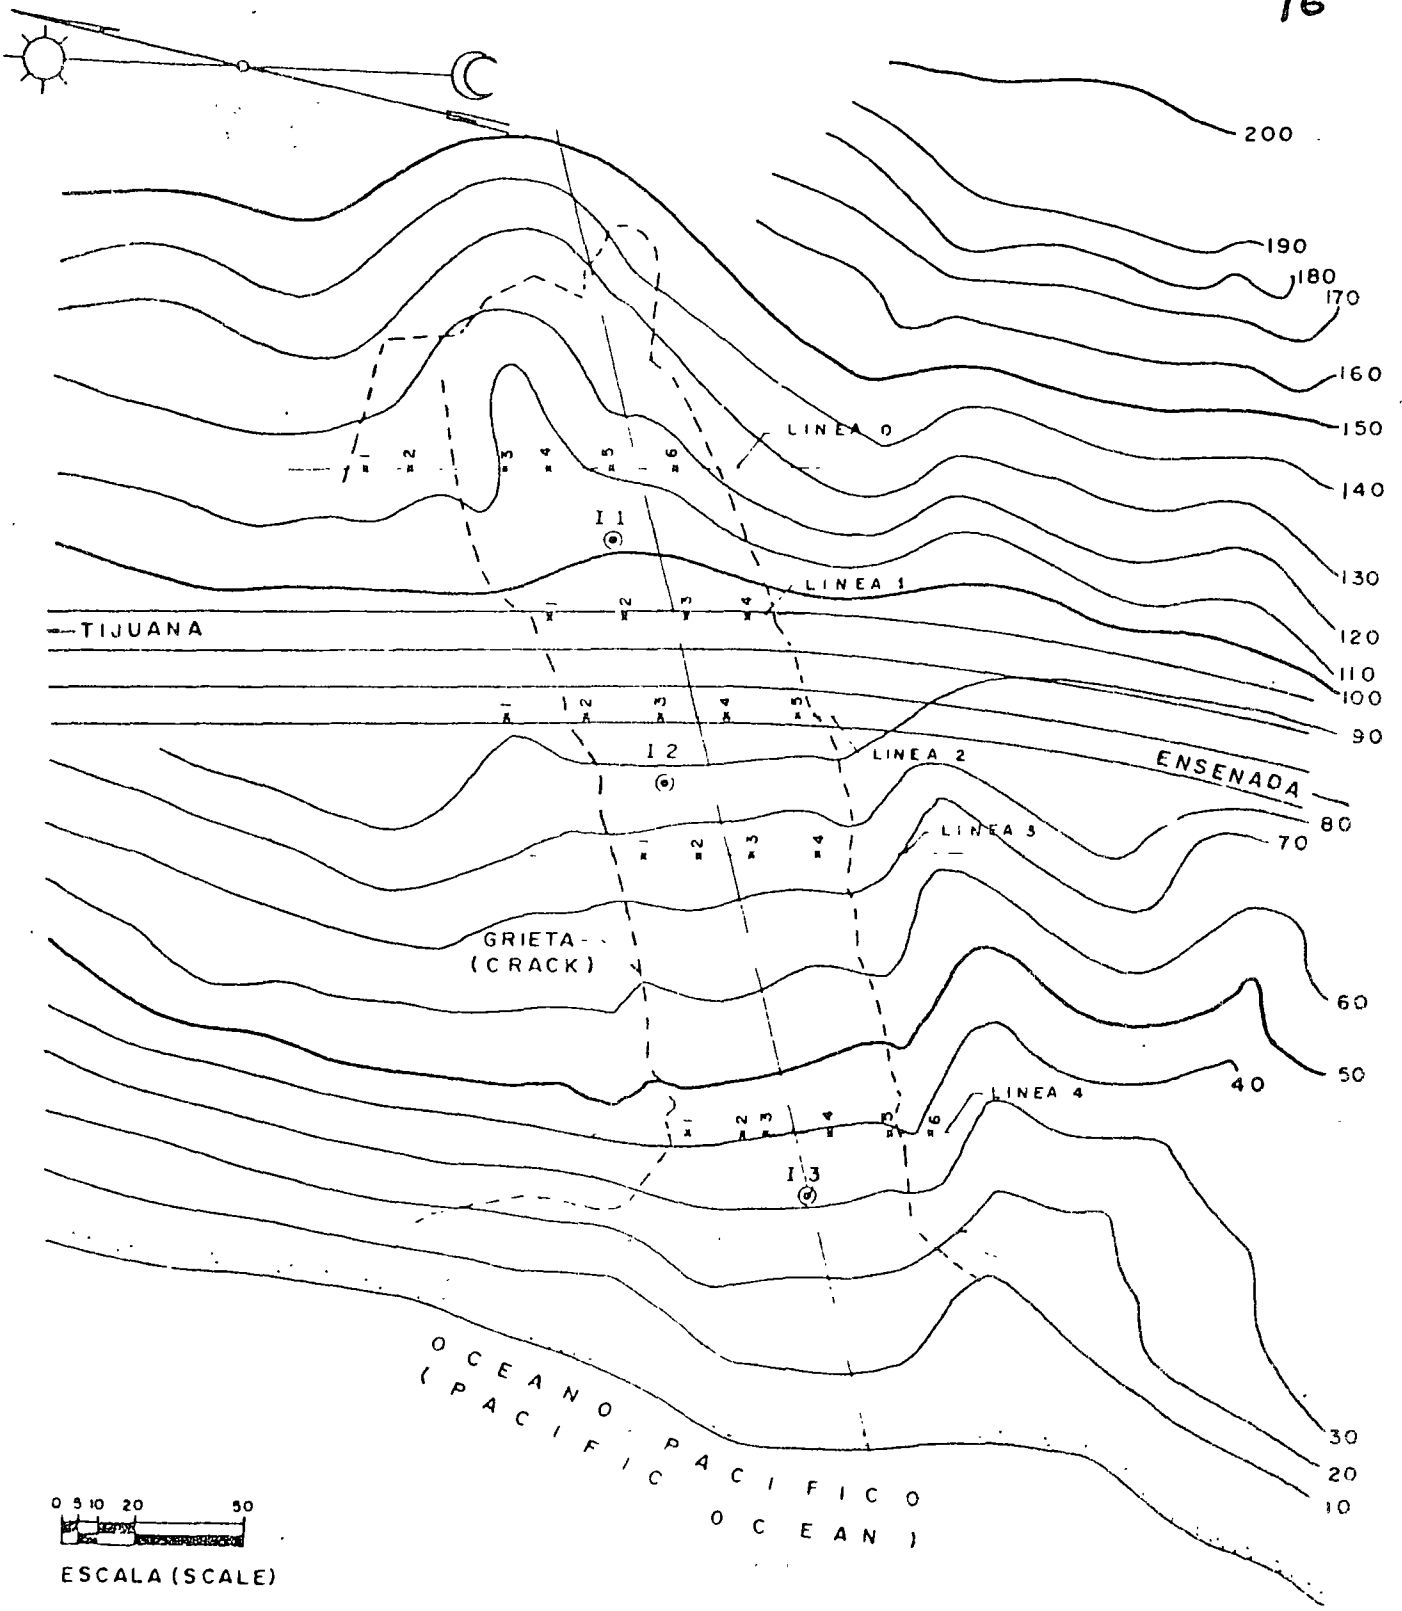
PLANTA TOPOGRAFICA DEL KM. 16+800
